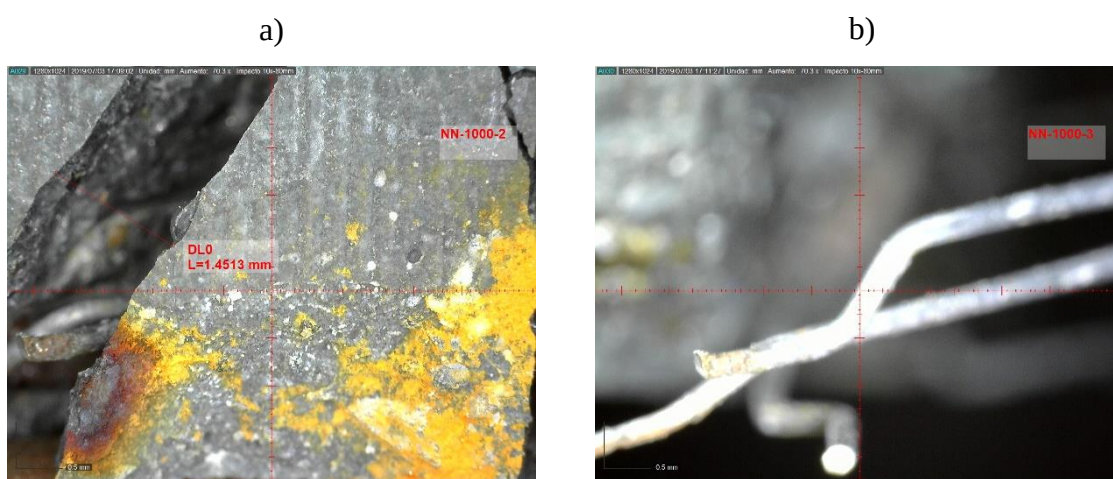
Arrancamiento de fibras en las vigas de HARRF con 80 kg/m^3 , velocidad de impacto 4.21 mm/ms ($H = 1000 \text{ mm}$). a) Fibra atravesando fisuras, b) Extremo de fibra arrancado.
